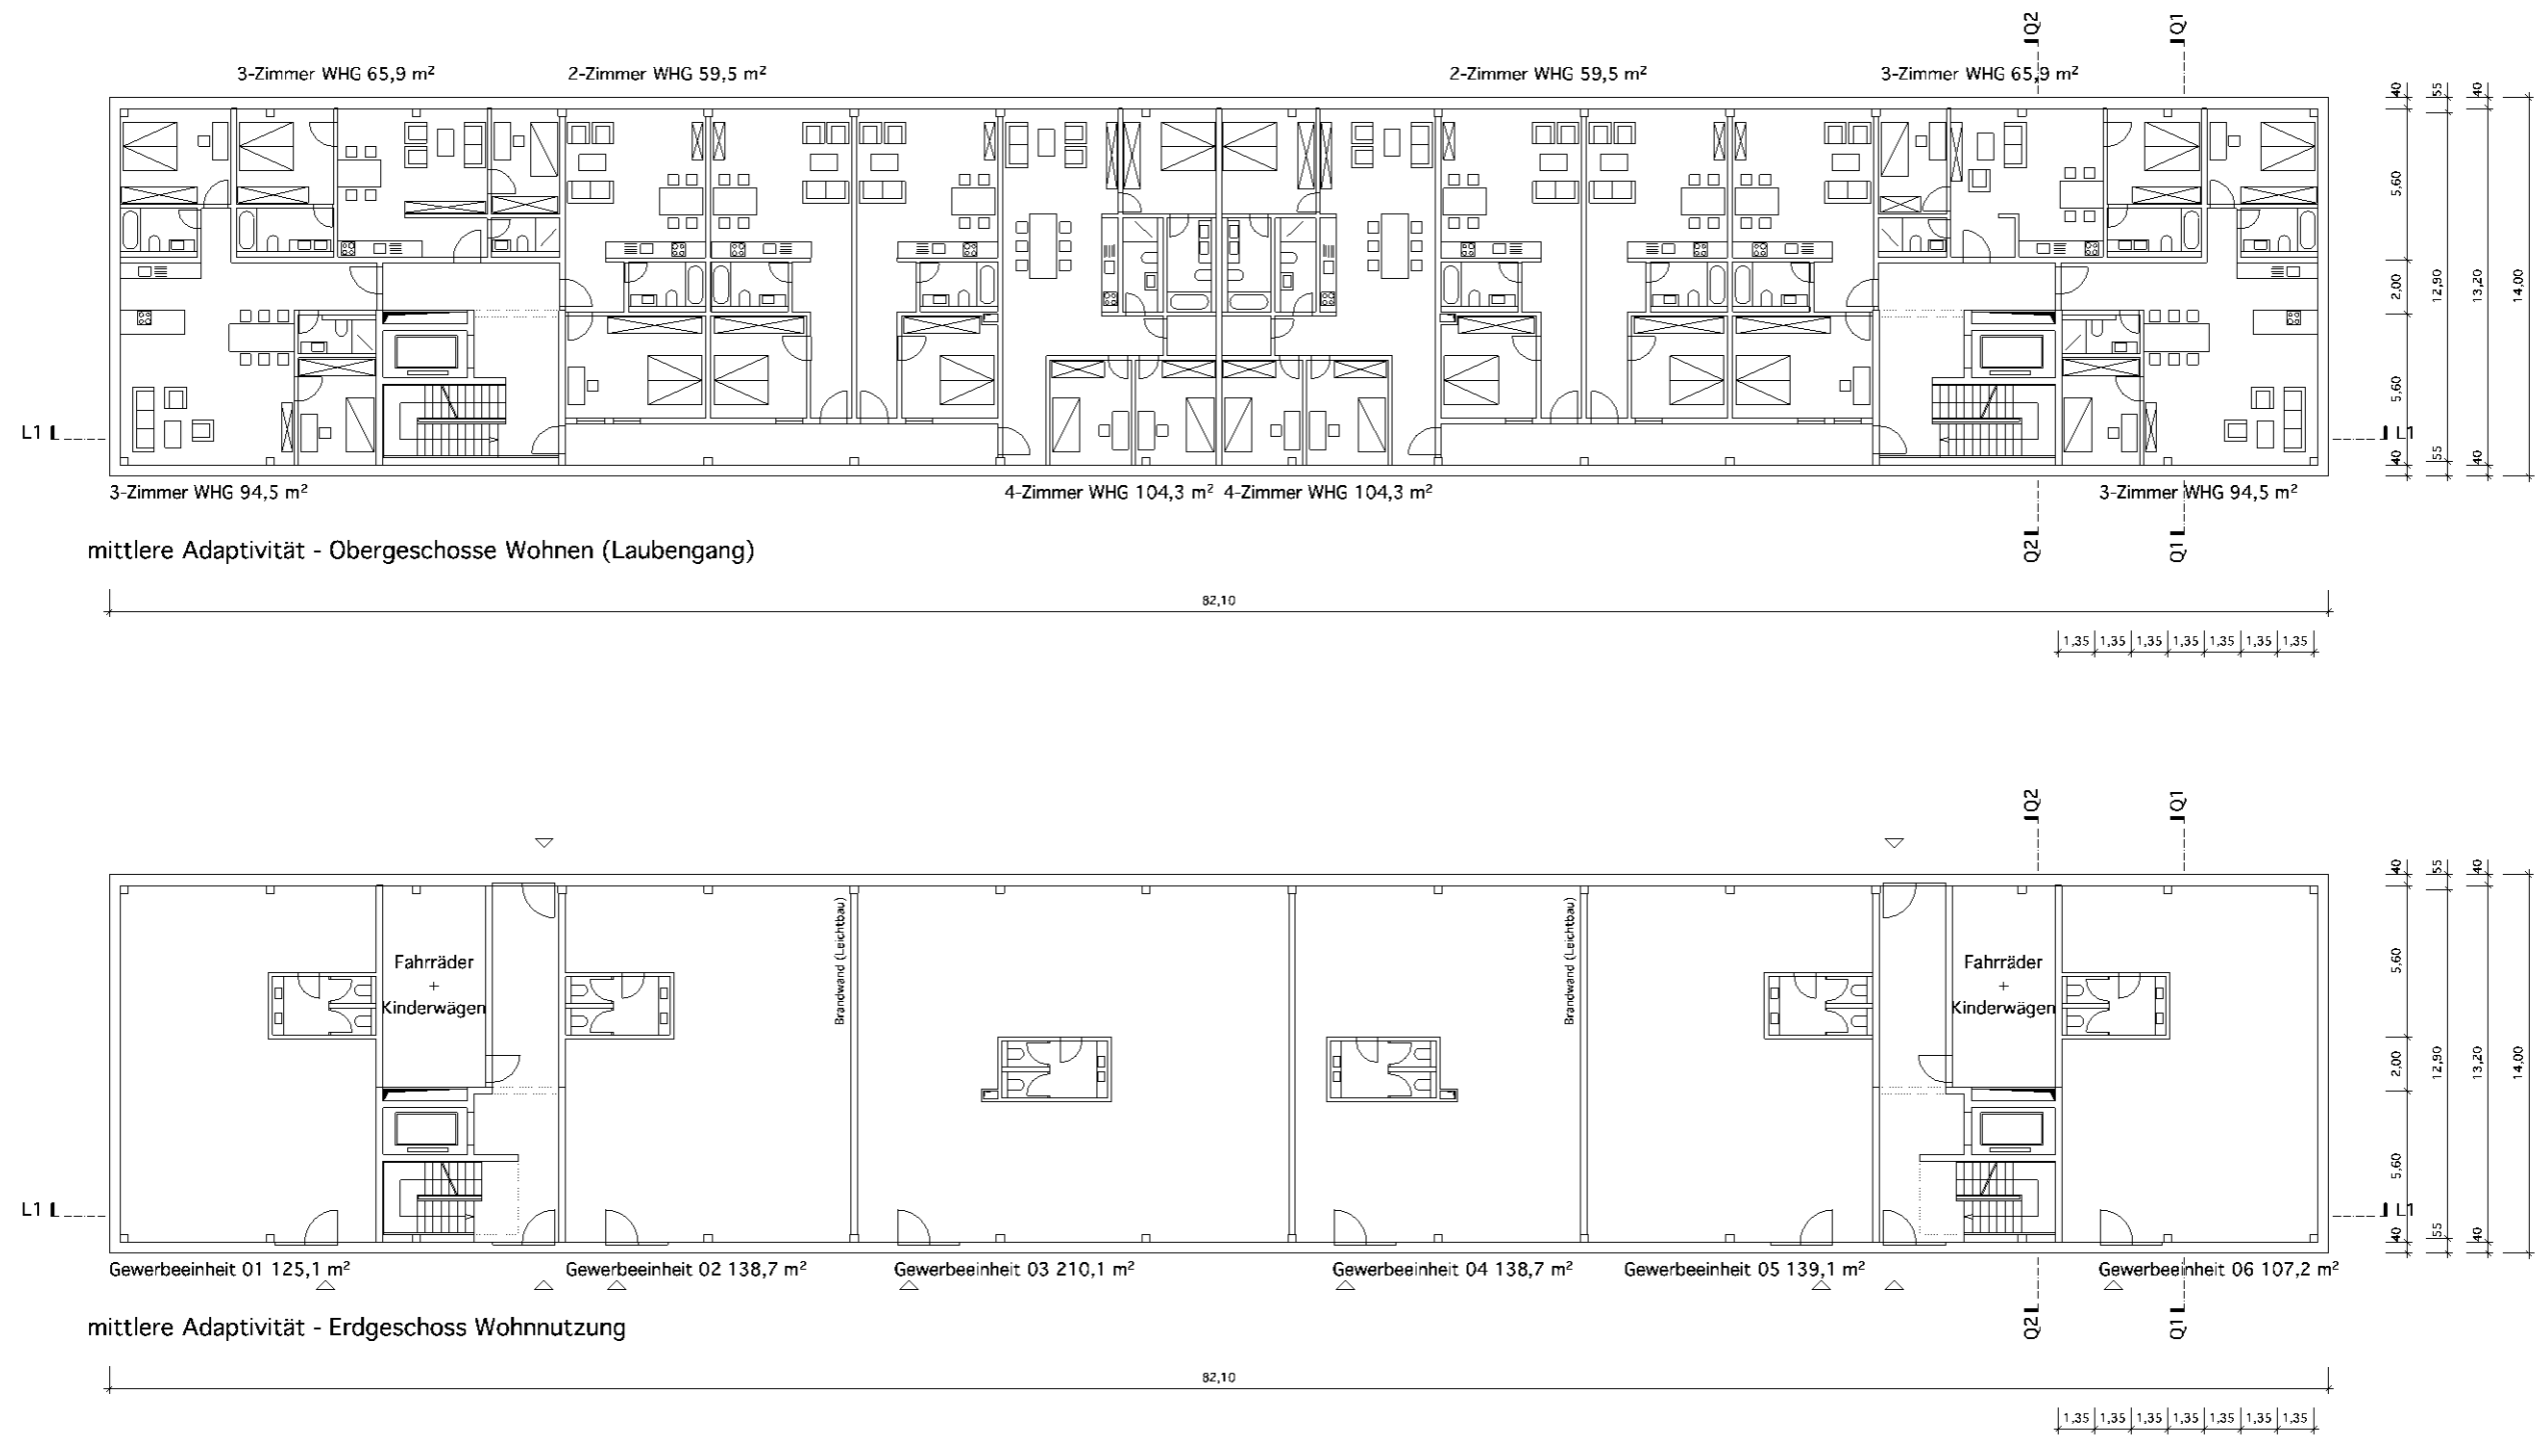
Grundrisse Obergeschoss (oben) und Erdgeschoss (unten) des Referenzgebäudes „mittlere Adaptivität“ für eine Wohnnutzung
